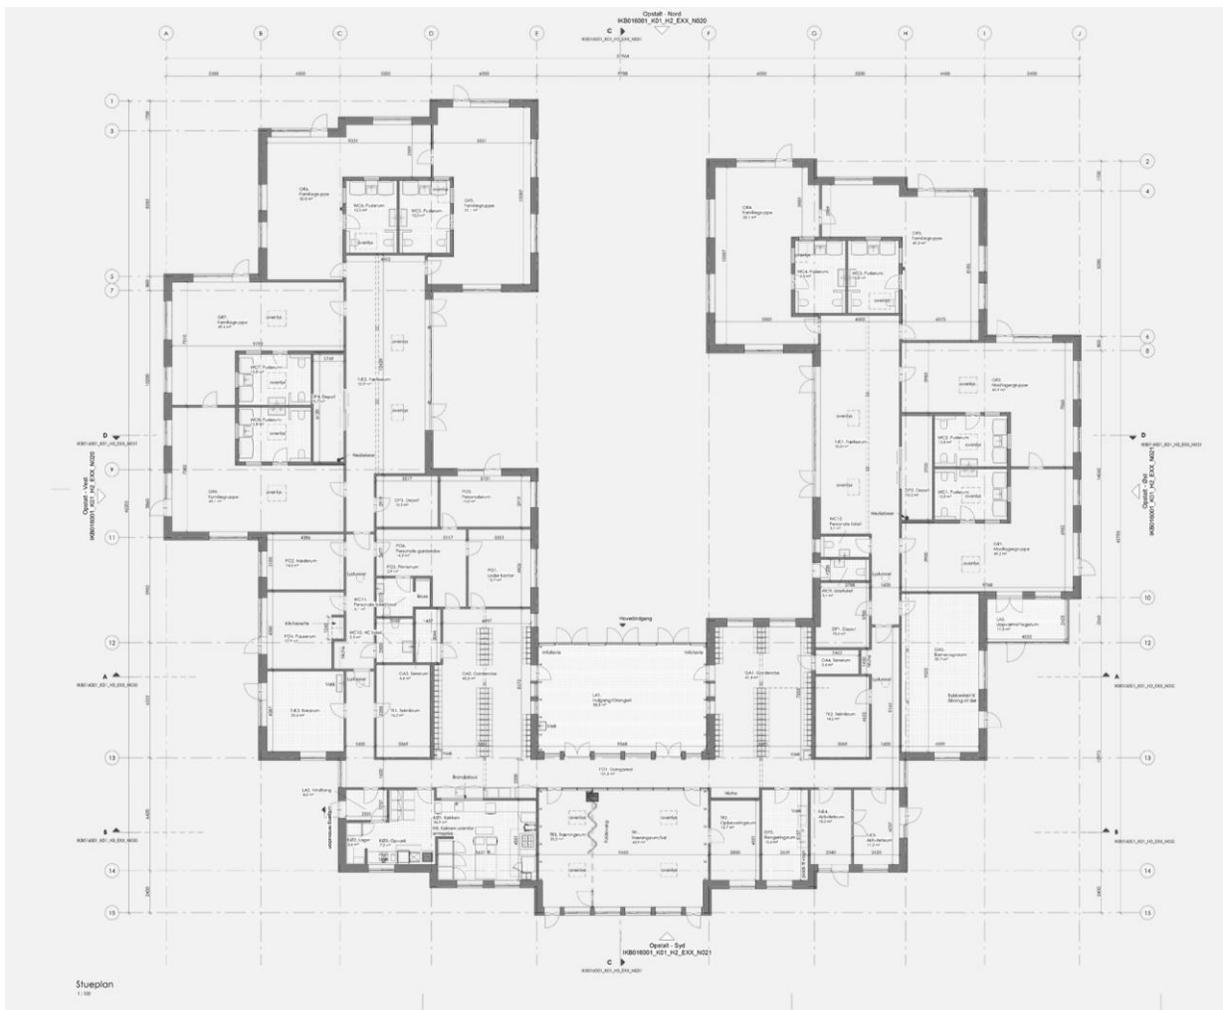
Planta arquitectónica the swan (Lendager,2022)
